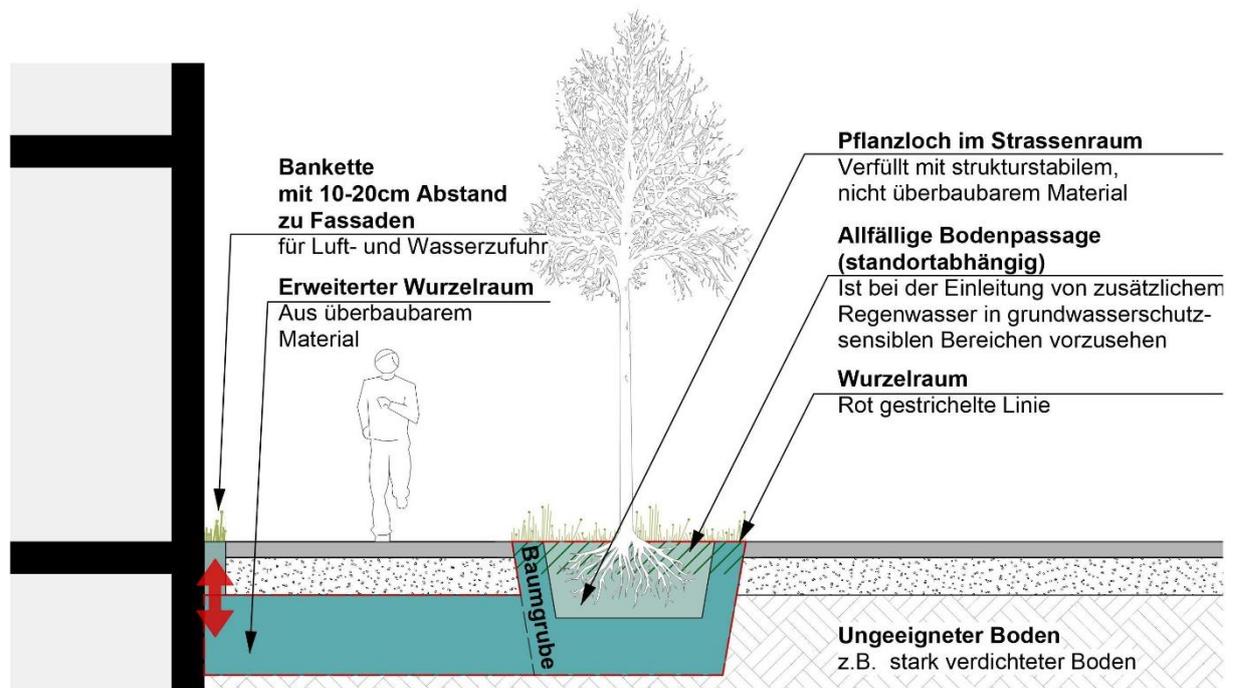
Vergrösserung des Wurzelraums zu einer Hausfassade hin. Verwendung von überbaubarem Substrat (Zielgrösse Wurzelraum 36 m^3 = rot gestrichelte Linie). Quelle: Stadtgrün Bern
